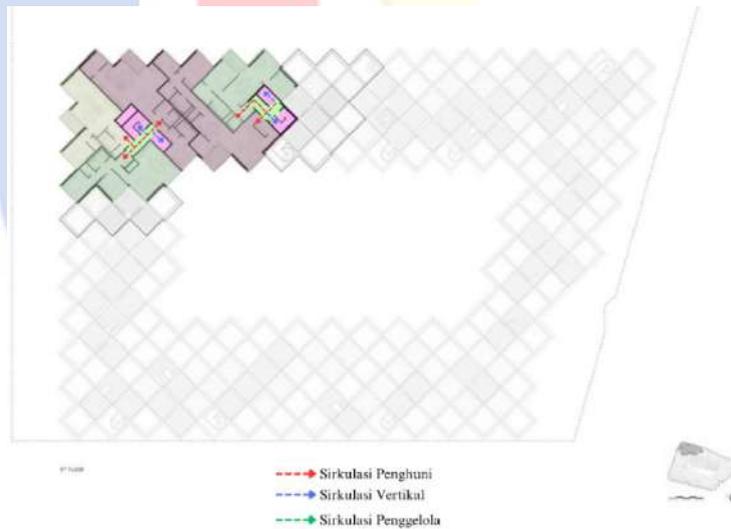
Denah Sirkulasi *3rd Floor* 79 & Park Residences
